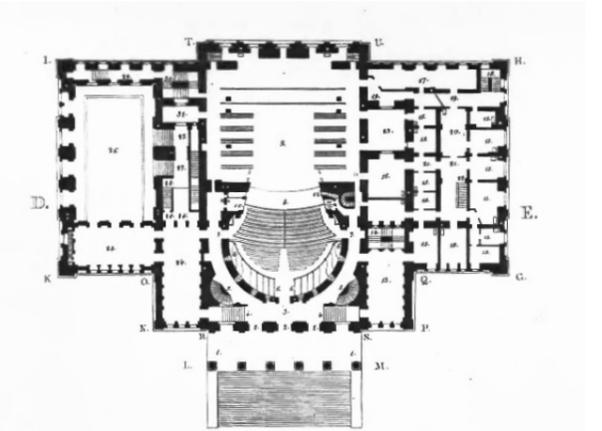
/ Planta baja, *Schauspielhaus* [Schinkel 1858, Lámina 9]
